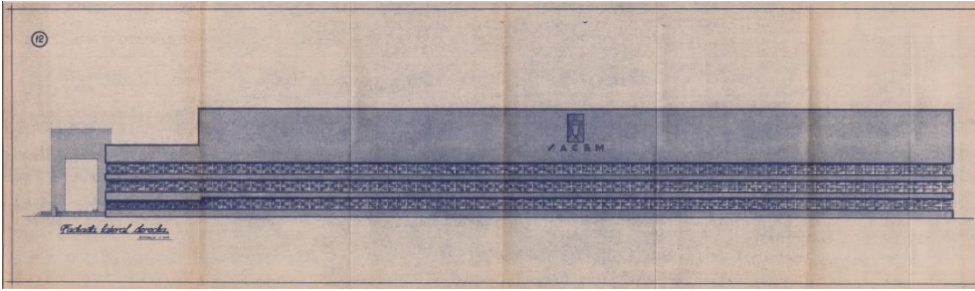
Fachada lateral del pabellón proyectado. (AMV 1939-1941)
